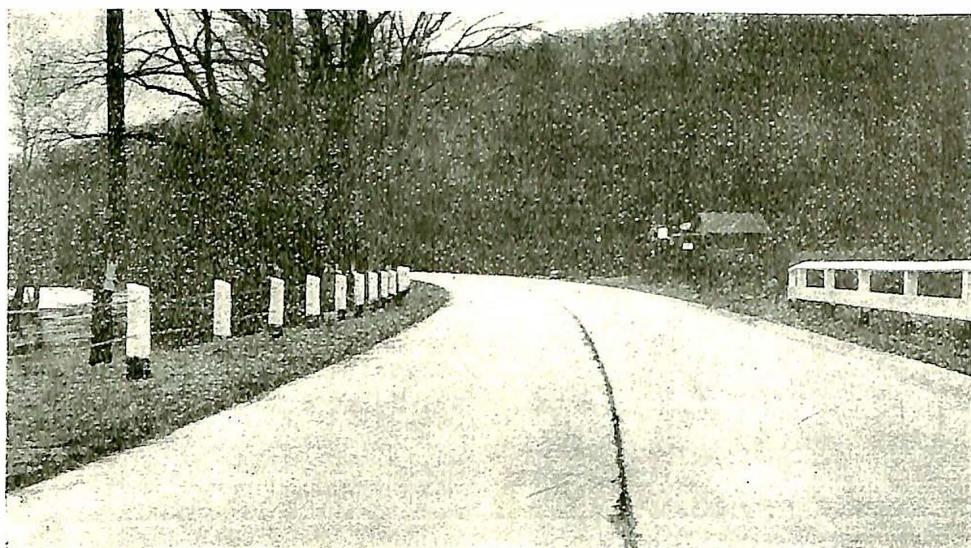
Betongvei Washington—Hackettstown, New Jersey, fuldført 1924.
